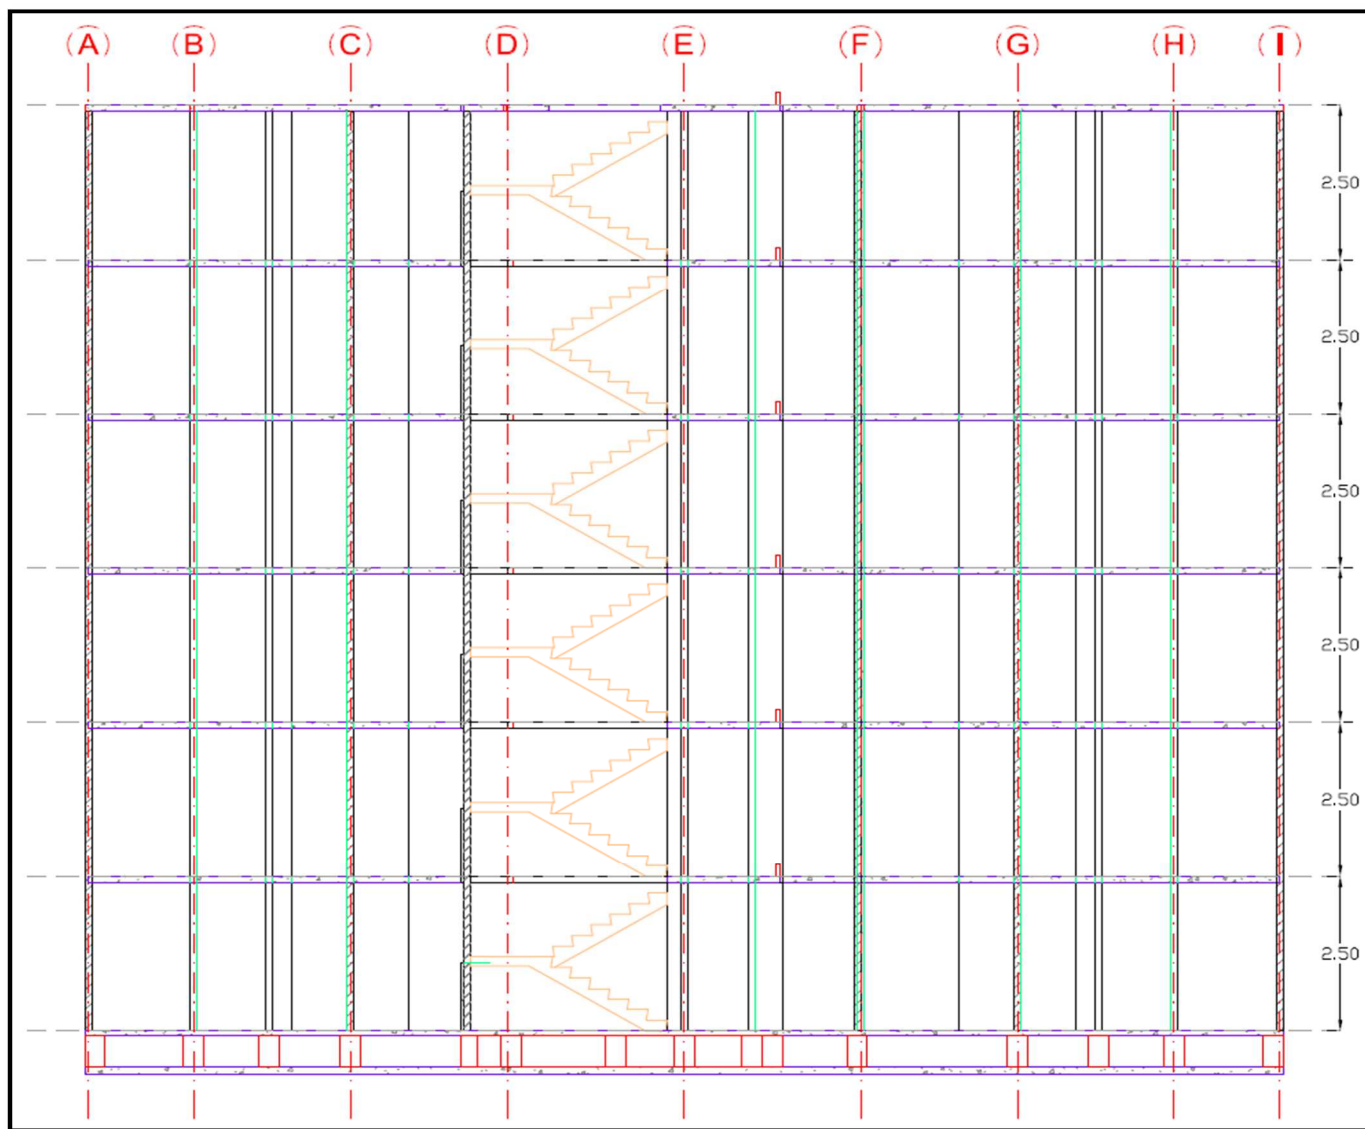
Alzado típico de una estructura analizada. Elaborada por la autora.
